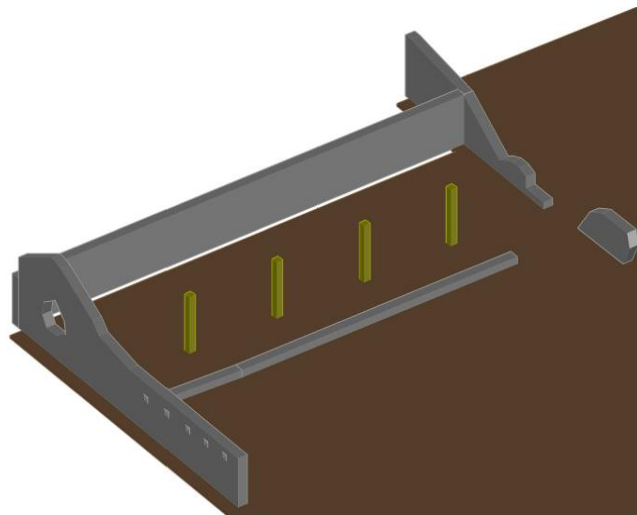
Edificio 1 Ex hacienda Cusi, Elaboración
